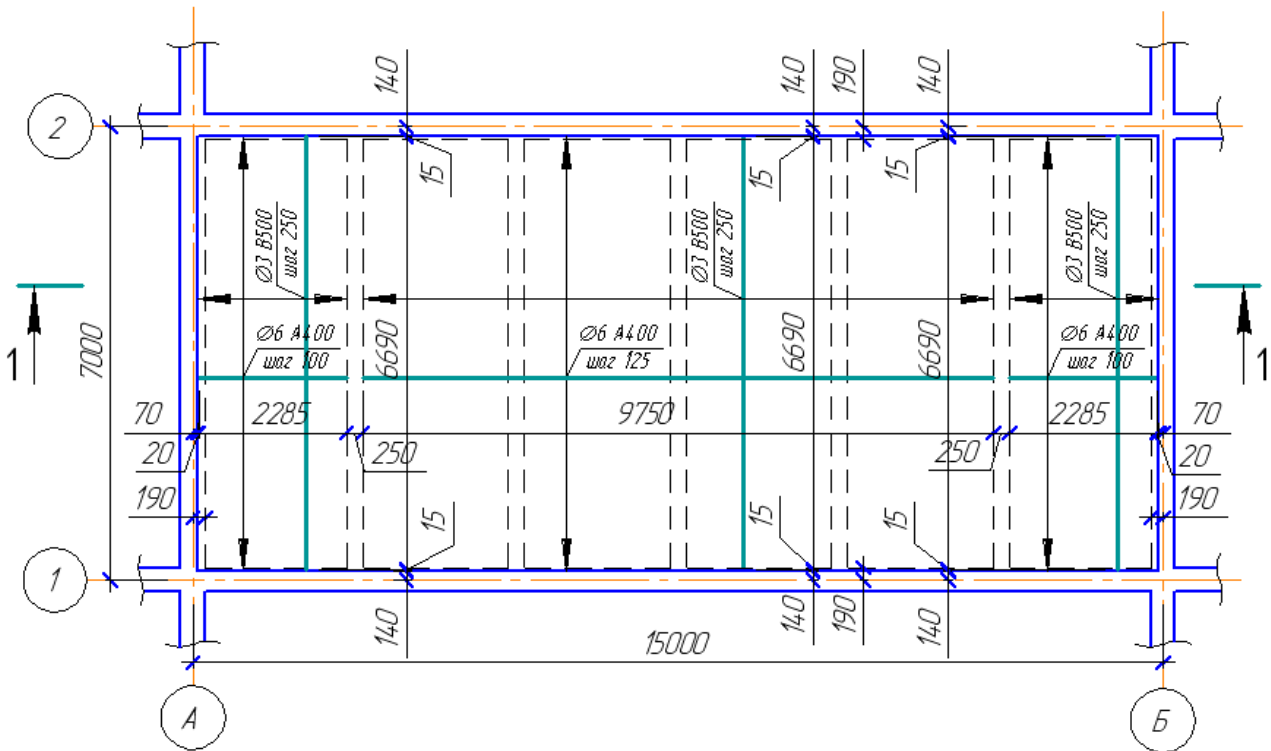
Схема раскладки нижней арматуры плиты перекрытия
